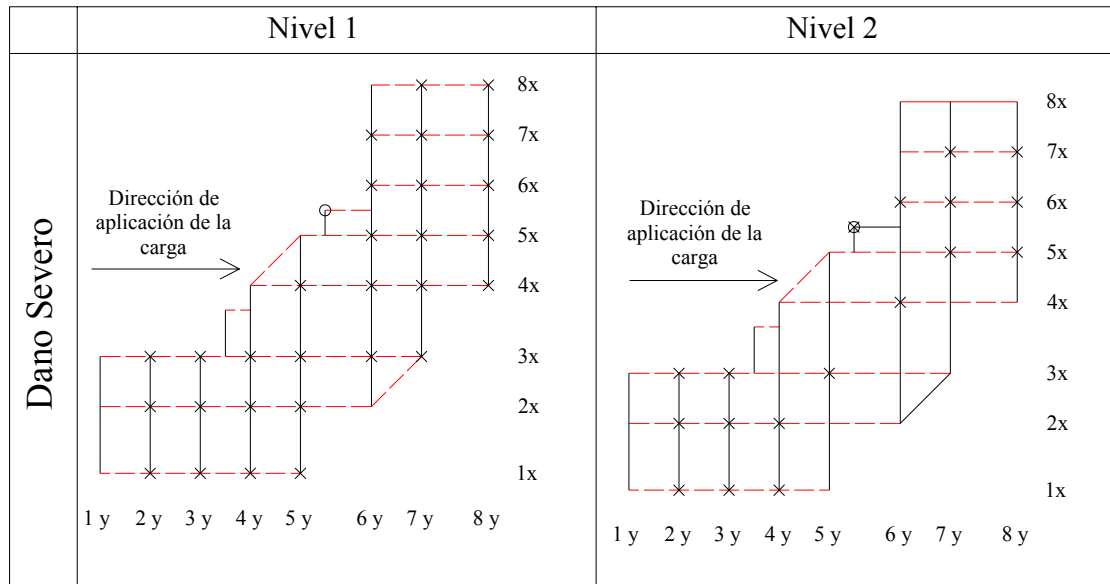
Vista en planta Niveles 1 y 2, para E.L. de D.S.
